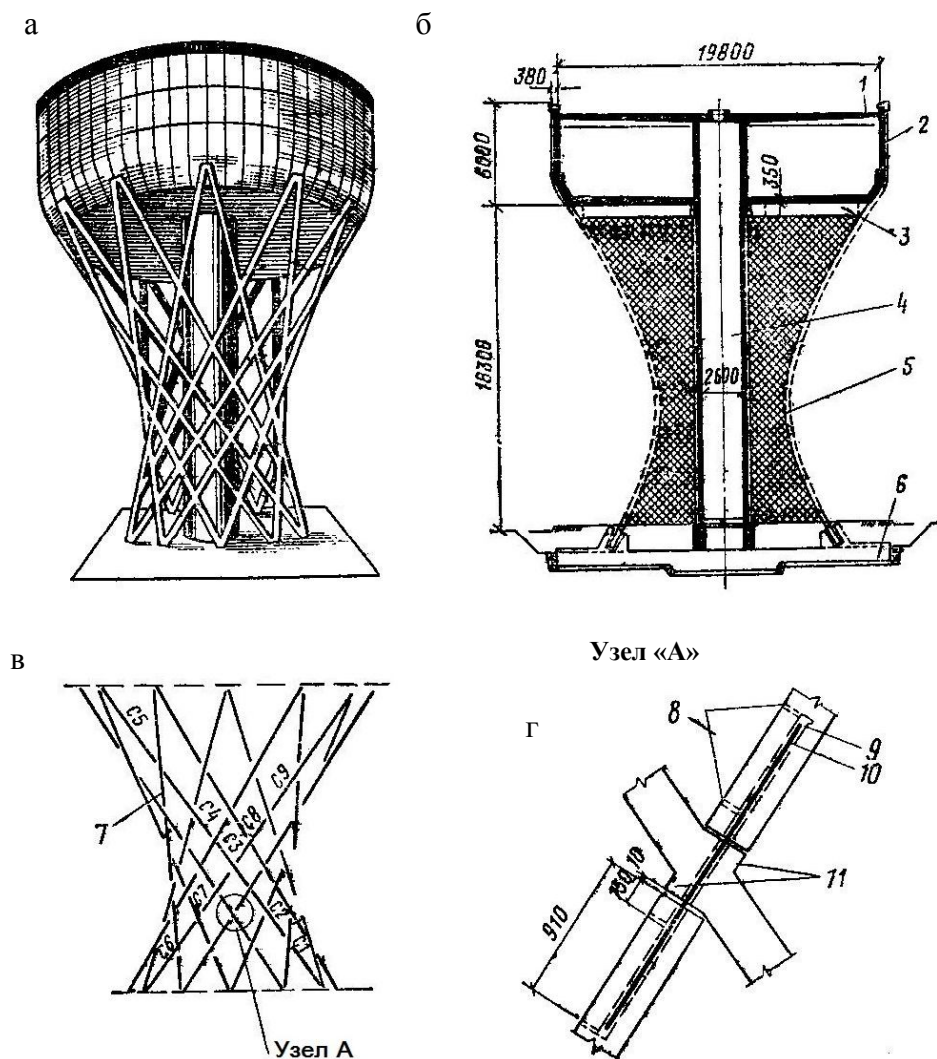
Водонапорная башня с опорой комбинированной конструкции: а – общий вид; б – вертикальный разрез; в – монтажная схема решетчатой части опоры; г – стык сборных элементов наклонных ног; 1 – покрытие резервуара; 2 – стенка резервуара; 3 – днище резервуара; 4 – центральная цилиндрическая часть опоры; 5 – решетчатая часть опоры; 6 – фундамент; 7 – ноги; 8 – отверстия для нагнетания растворов; 9 – гнездо; 10 – стальной штырь; 11 – двухсторонние выступы ног
